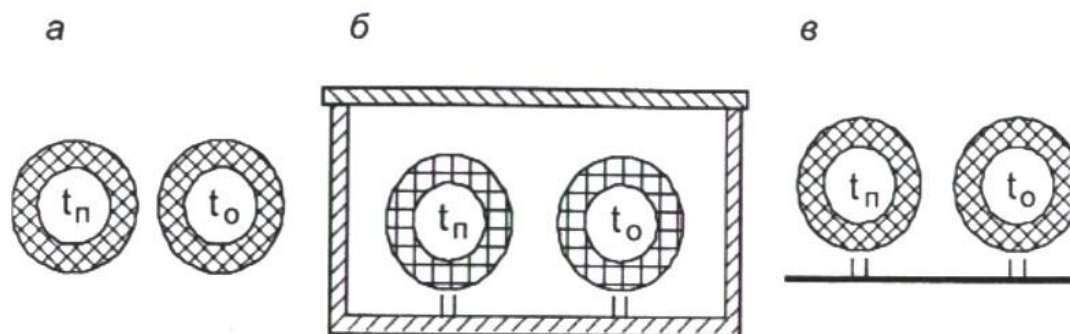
Схемы конструкций типичных теплопроводов замкнутой системы теплоснабжения: а - подземный предызолированный теплопровод с заводской изоляцией из пенополиуретана; б - подземный теплопровод в непроходном канале с изоляцией из минеральной ваты; в - надземный теплопровод
